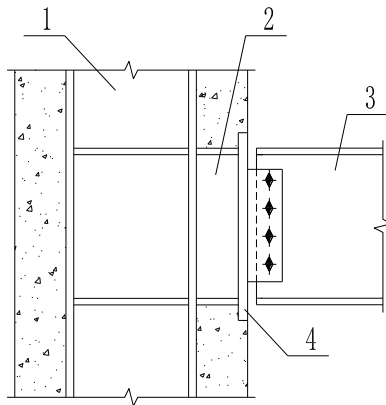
钢梁与型钢混凝土柱的铰接
